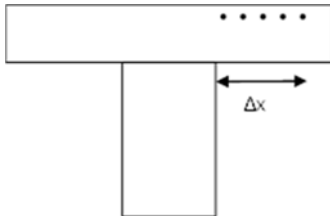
Plattenbalken mit ausgelagerter Biegezugbewehrung
